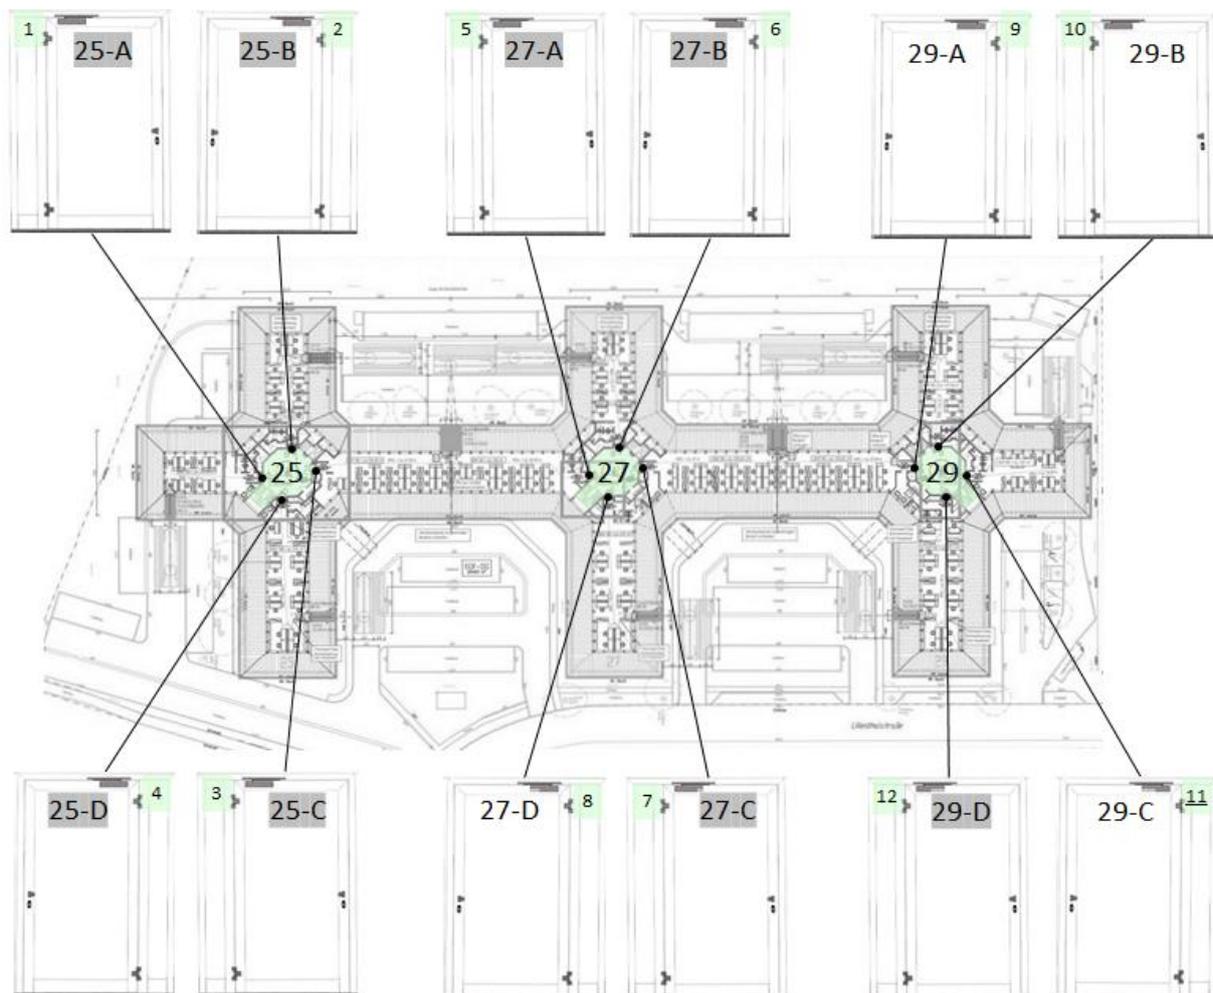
Verortung der Türen im Grundriss DG
